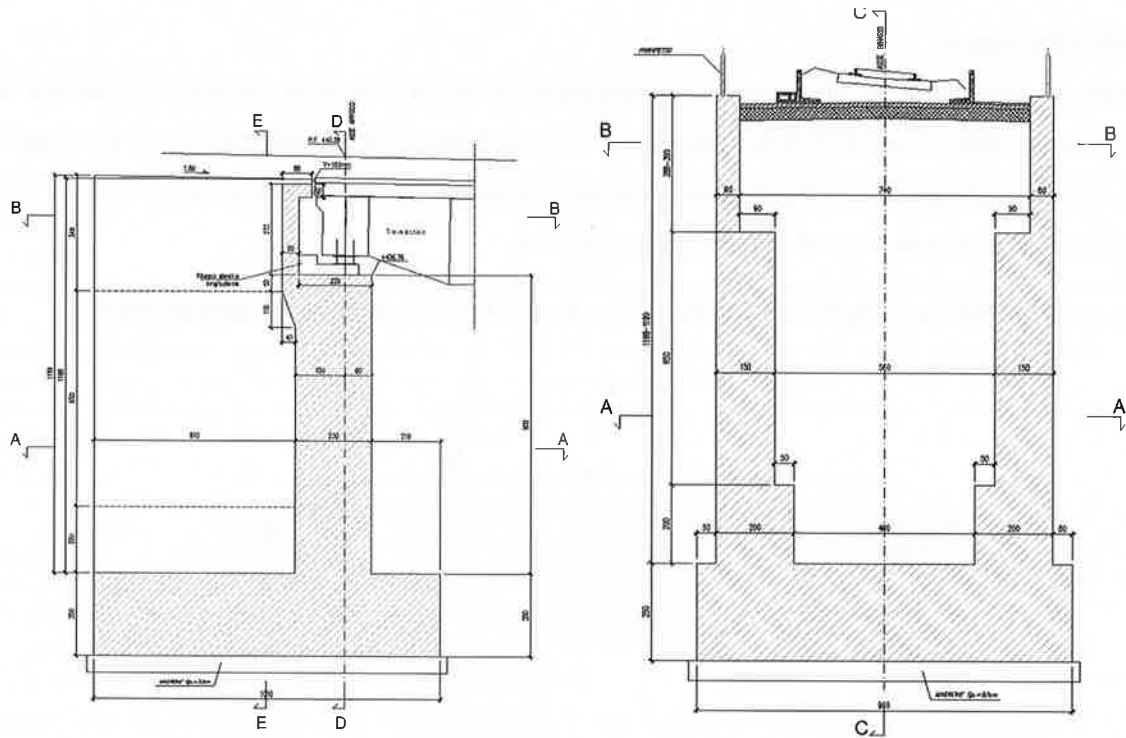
Sezione longitudinale e trasversale spalla A Bonorva VI01
